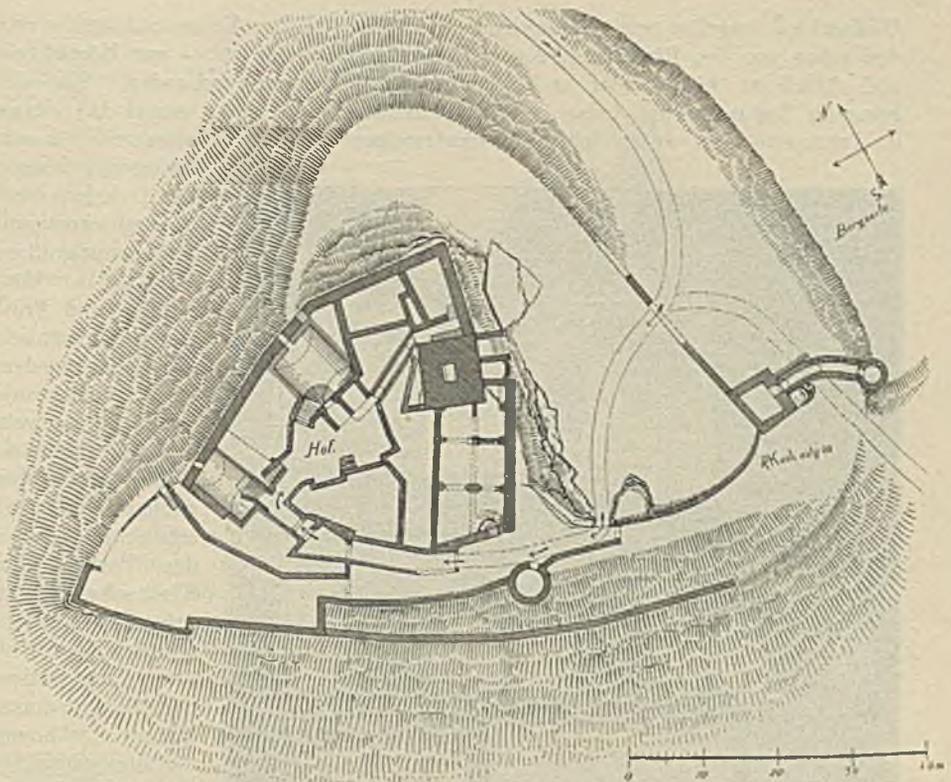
Grundriß einer Burg mit Bergfried und Palas
